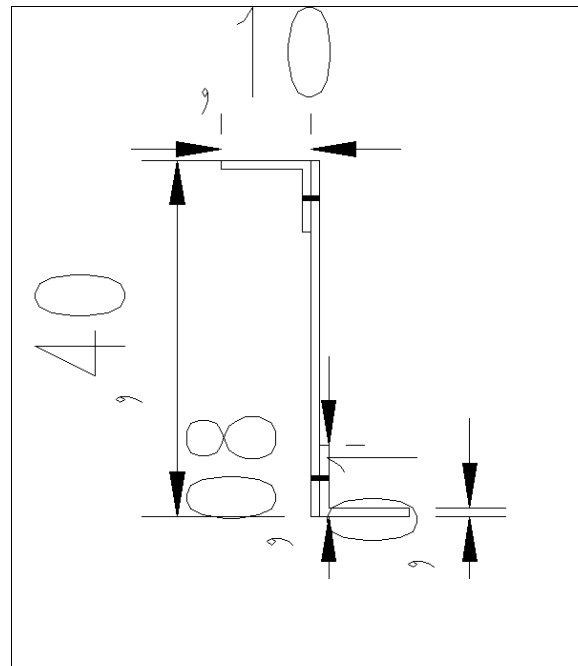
Sección del elemento tipo 2-26, Puente 2. Fuente (Autores).
